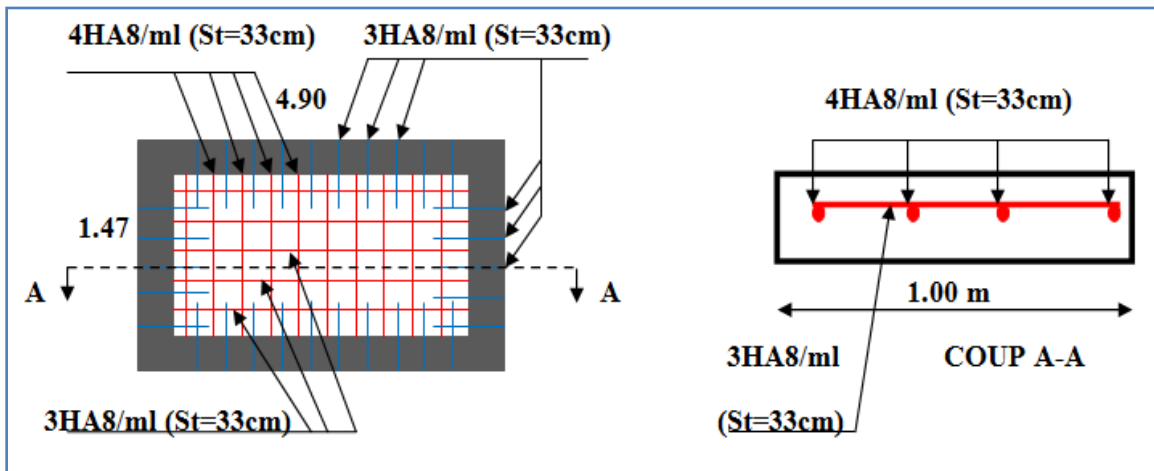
Schéma de ferrailage de la dalle sur quatre appuis.
